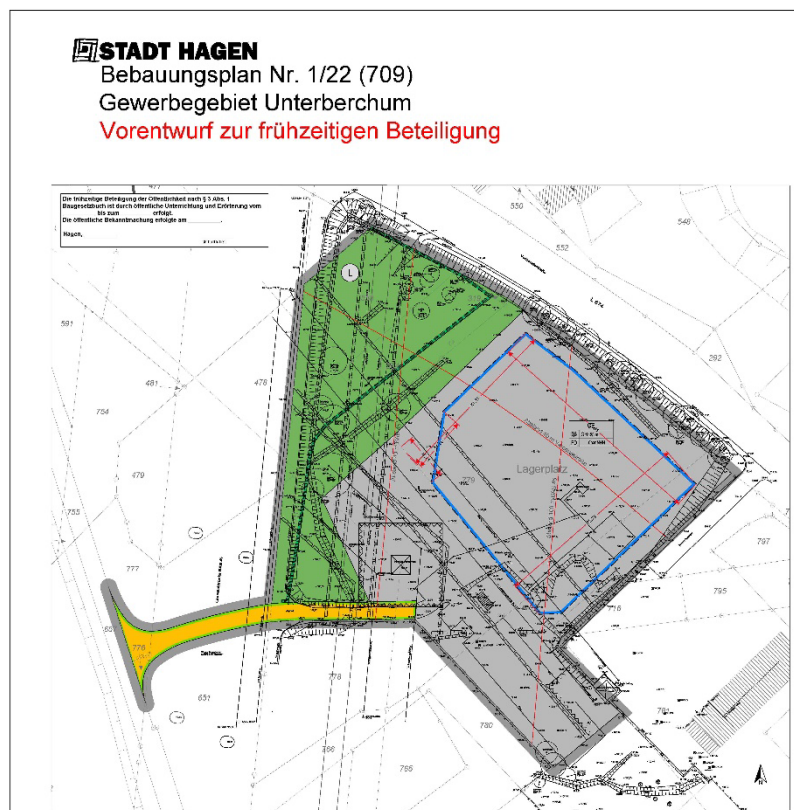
B-Plan Vorentwurf Stadt Hagen²
